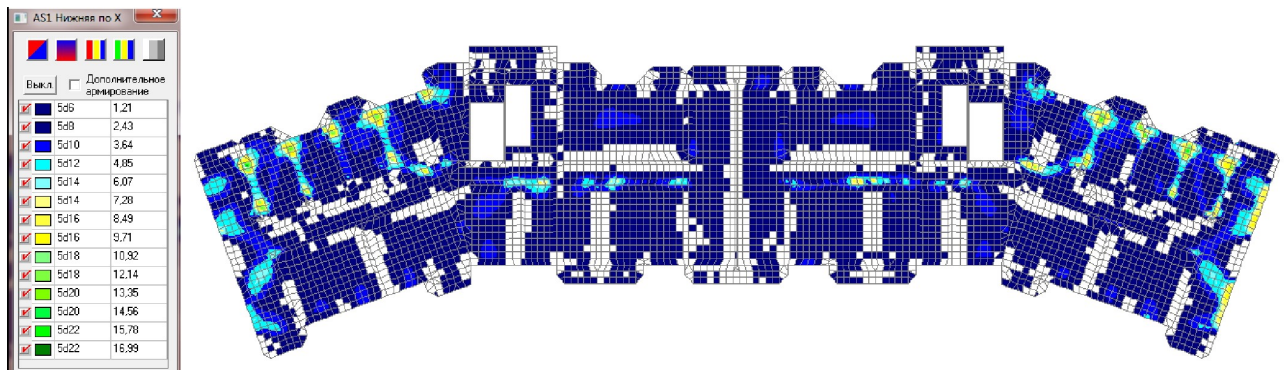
Армування плити перекриття типового поверху нижнє за X
